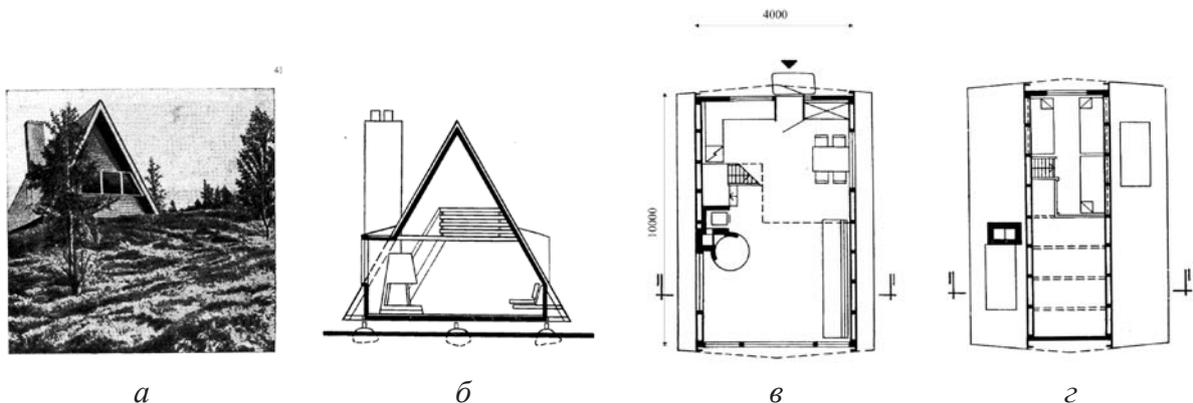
Домик на одну семью. Арх. Ф. Гедерус (Швеция): *а* — общий вид; *б* — разрез; *в* — план 1-го этажа, *г* — план 2-го этажа
